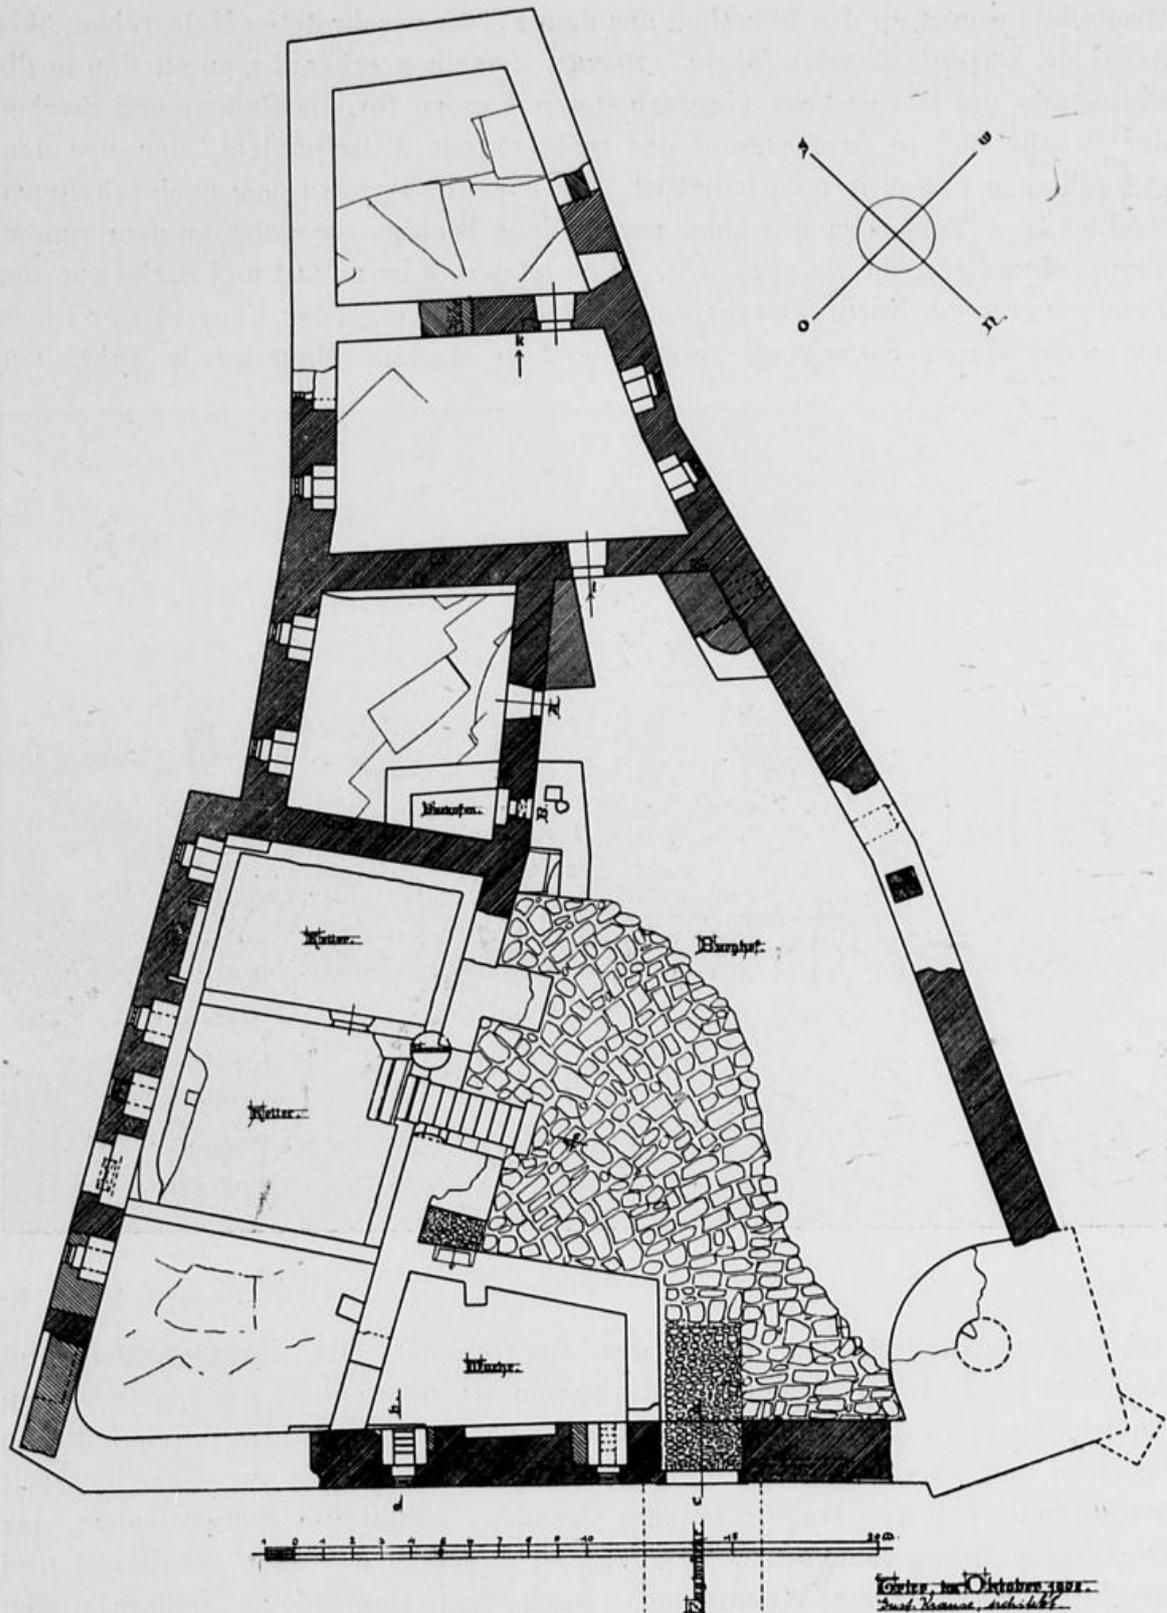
Ruine Freudenburg. Grundriss des Erdgeschosses.
